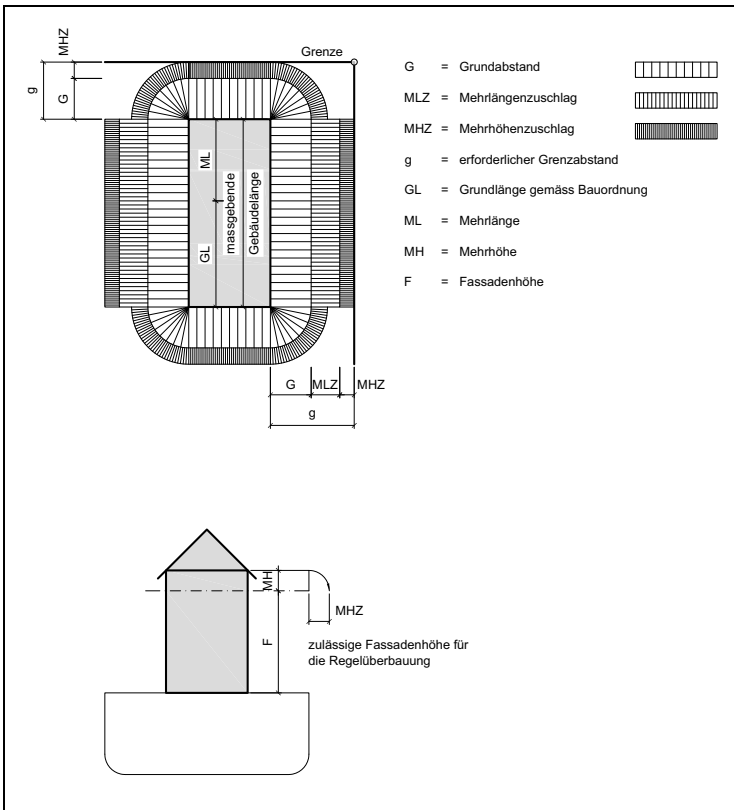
Bebaubarer Bereich und Baubereich (§ 7 ABV)
